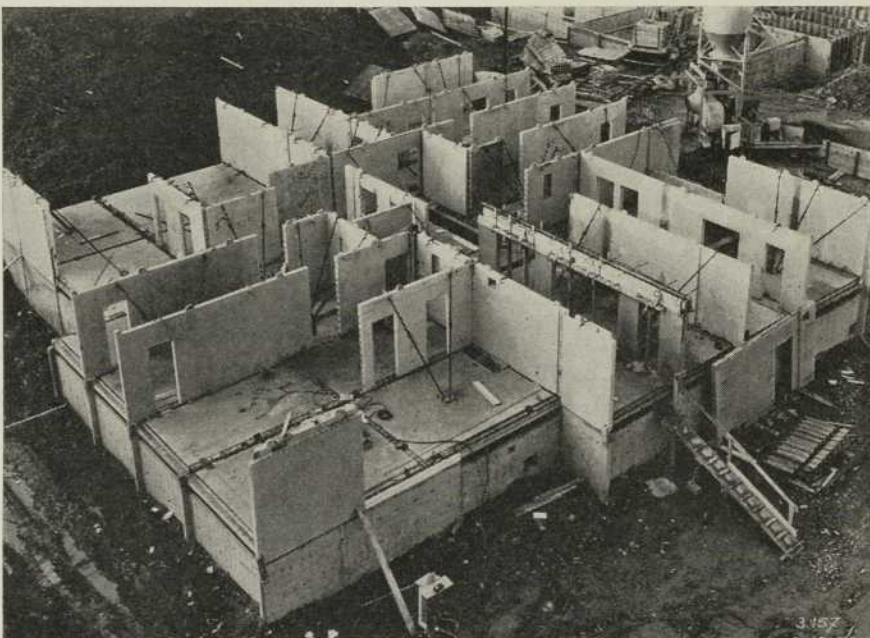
Le montage à chaque niveau débute par la pose des dalles de planchers.
